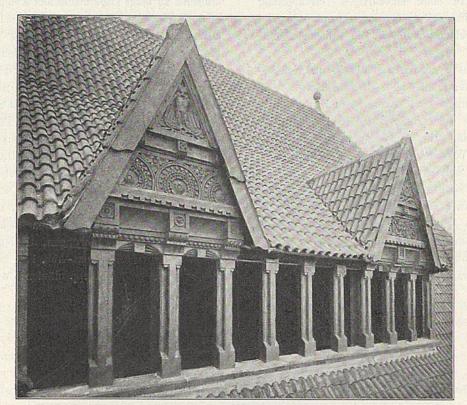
Hölzerner Dachaufbau der Vorderfront.
